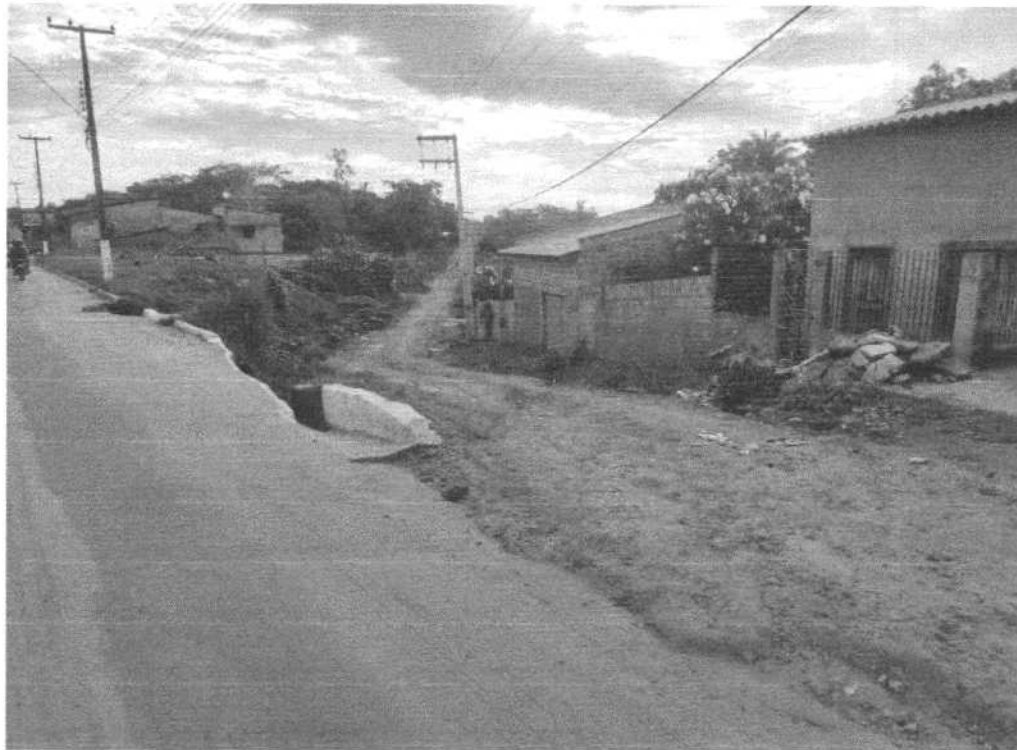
INICIO DA PAVIMENTAÇÃO
